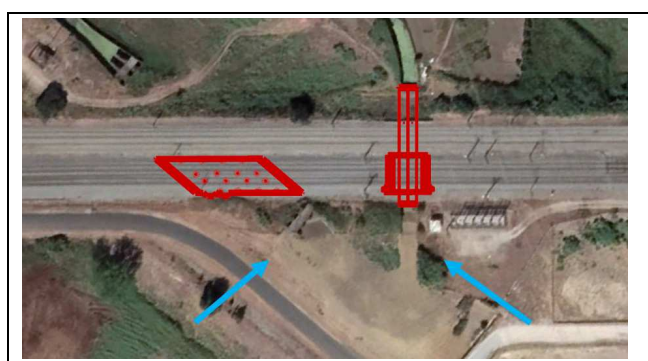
Canal de Restituição - Estrutura de proteção (ver ponto 3.1)
